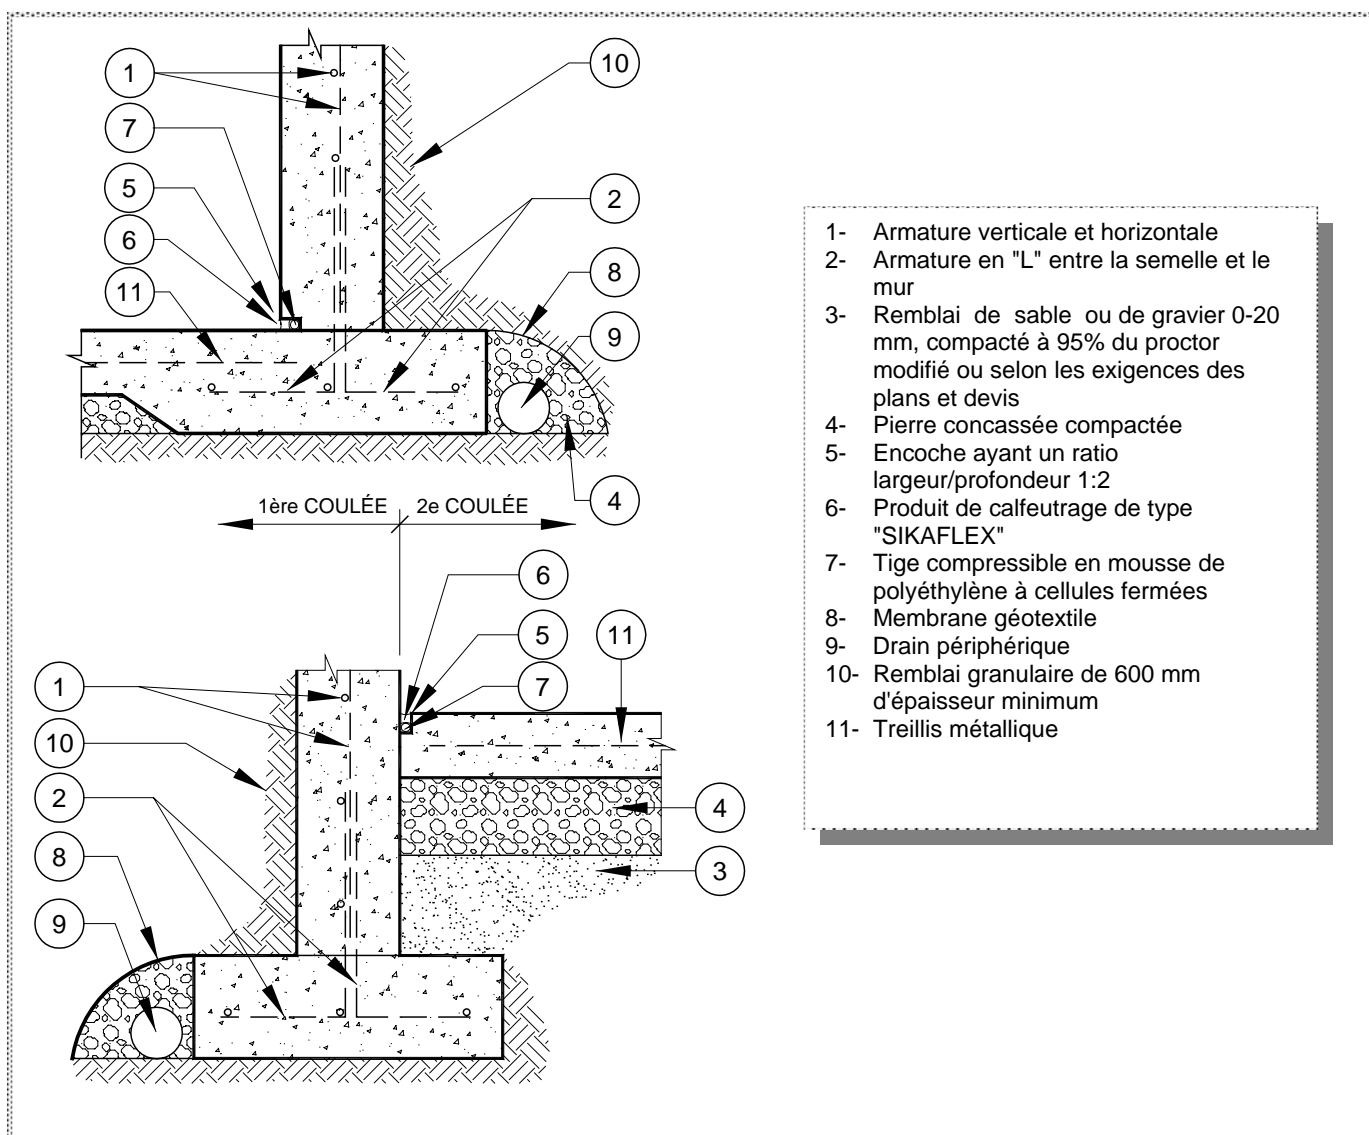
Étanchéité entre la dalle et le mur ou la descente (Joint de construction)
